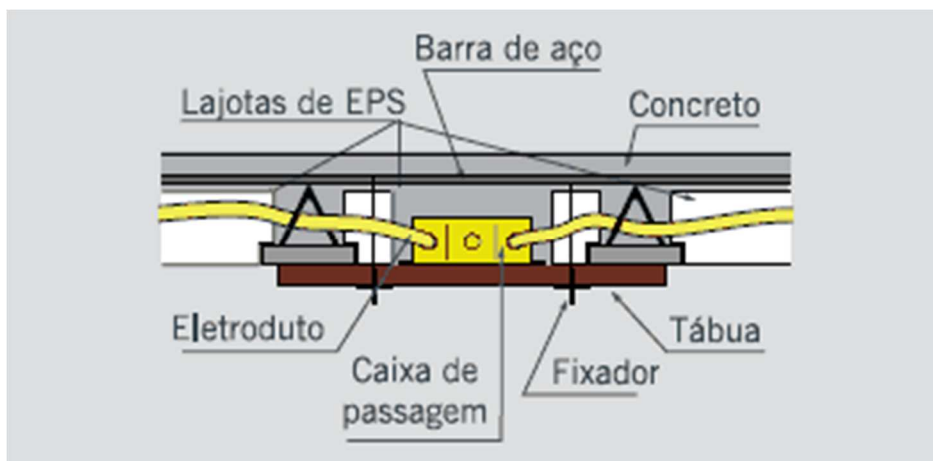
Tubulação e caixa de passagem elétrica em lajes.
